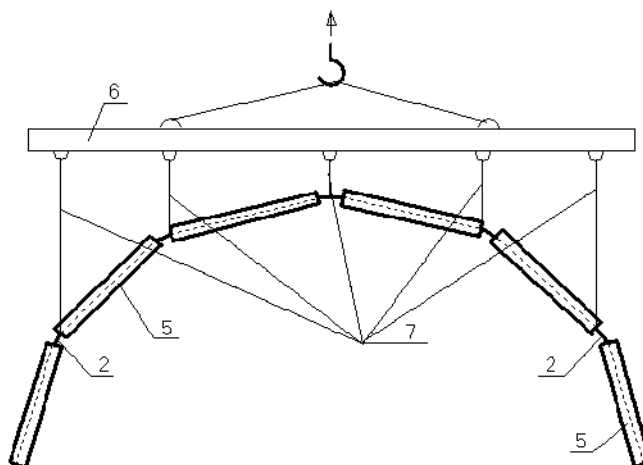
Схема придания формы железобетонному своду путем его подвешивания
